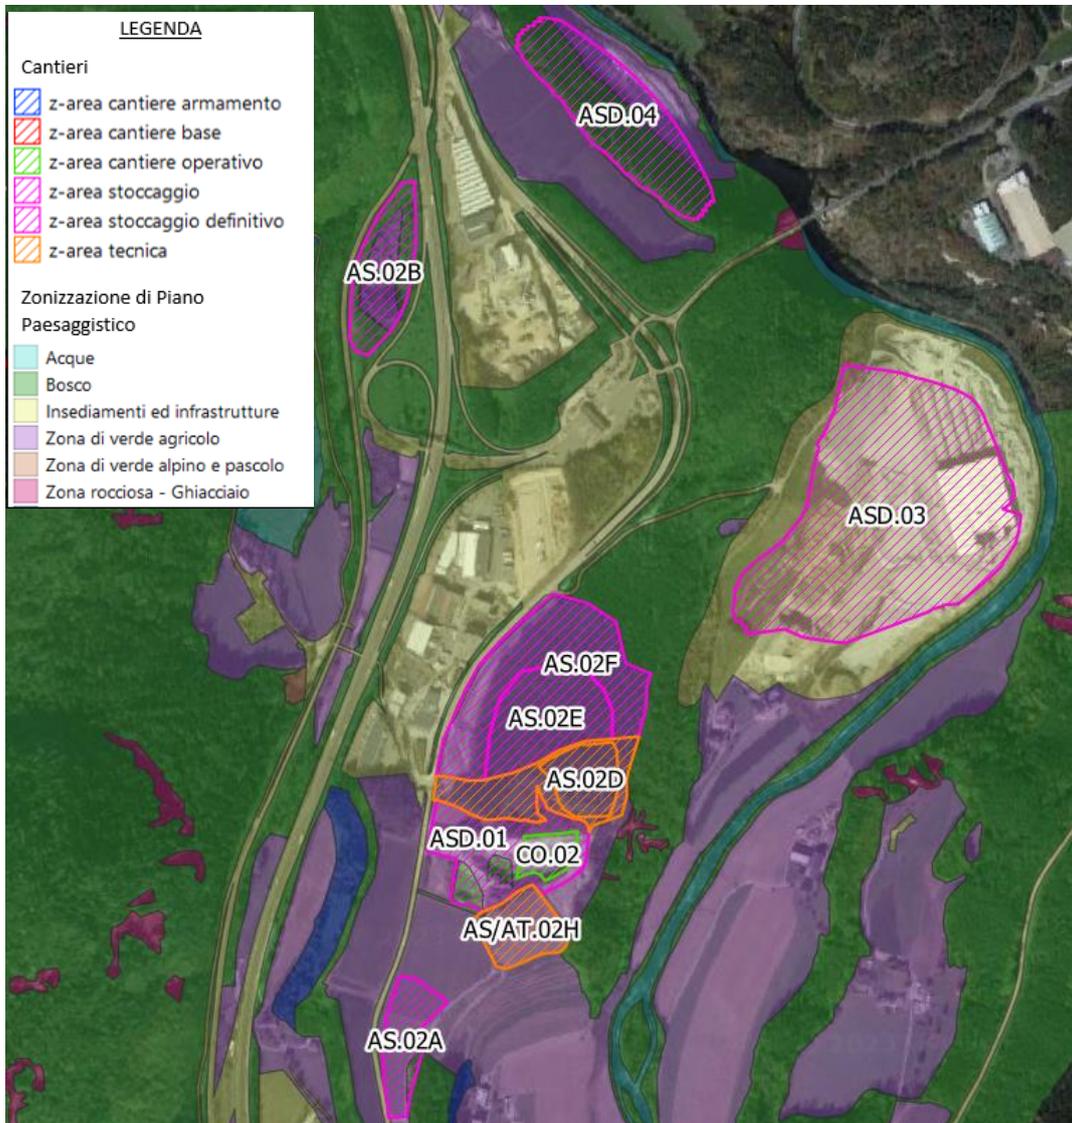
Individuazione delle aree di cantiere dell'ambito Forch con relativa zonizzazione di piano – Progetto Esecutivo
